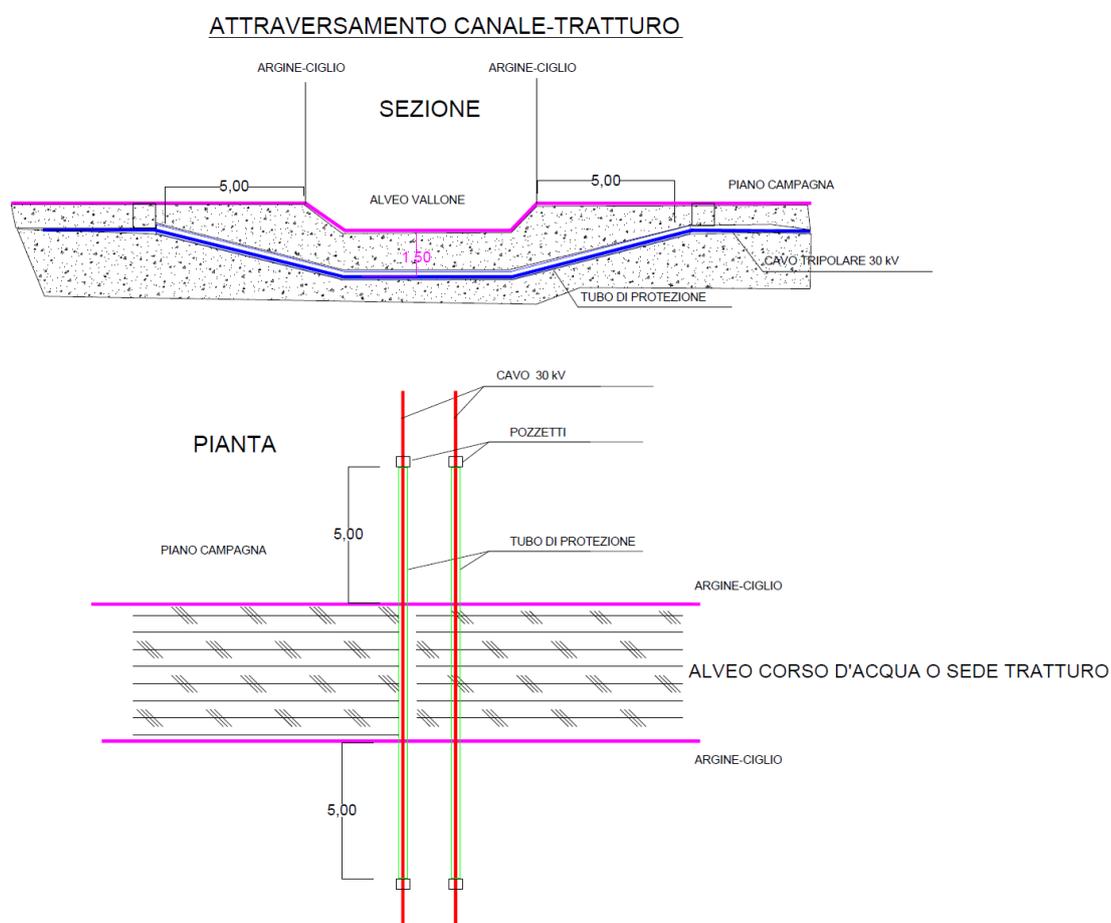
planimetria e sezione di un attraversamento in sub-alveo.
